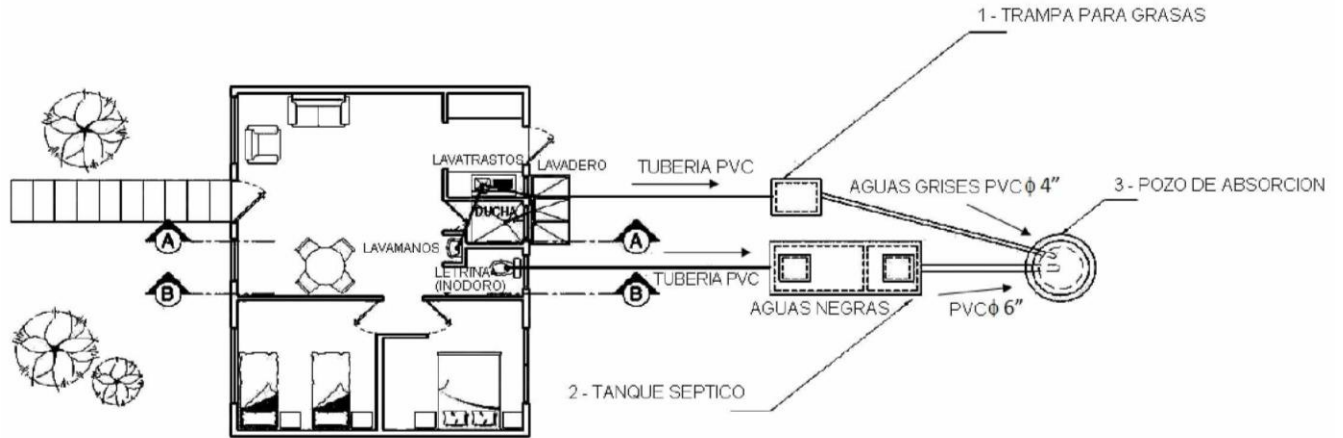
Esquema en planta de un sistema de tratamiento individual, Sin Escala
